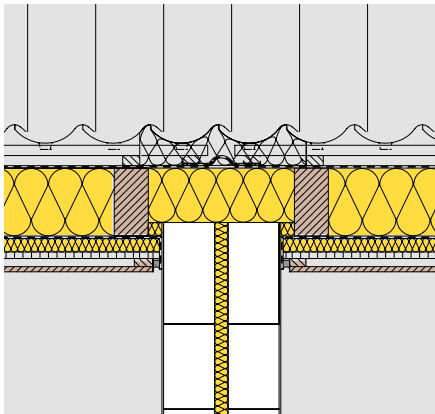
Dachanschluss bei einer zweischaligen Haustrennwand ohne durchlaufende Dachlatten
